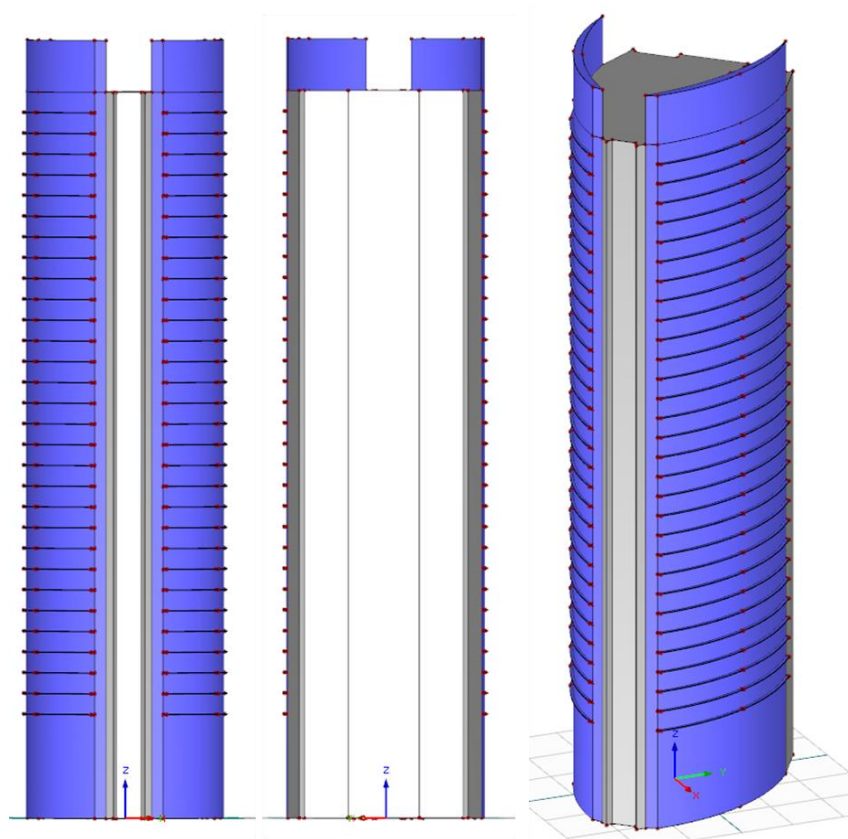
3: Prospetti e vista assonometrica dell'edificio del caso studio A
